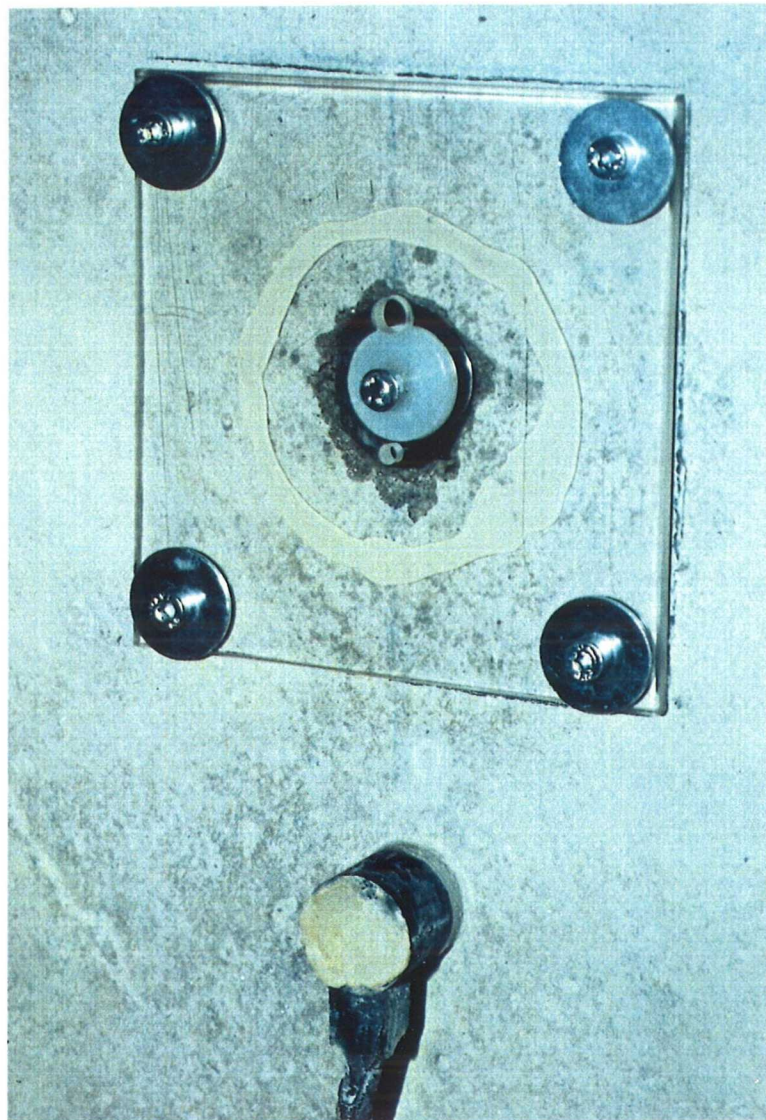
Eingesetzte und ausgerichtete Multi-Ring-Elektrode
